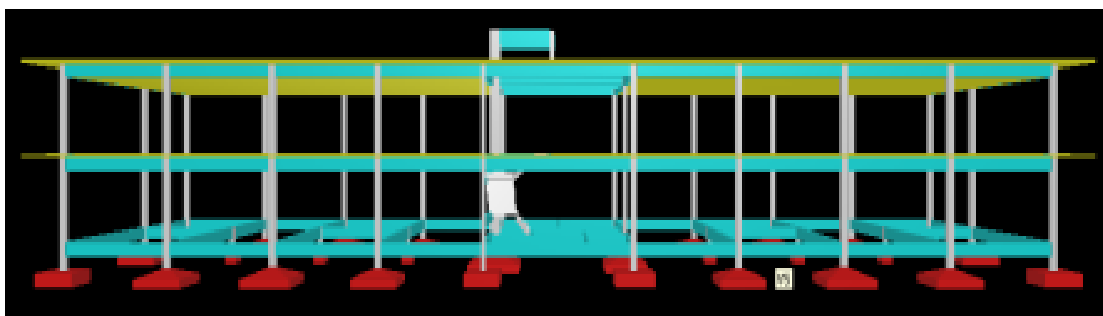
Pórtico 3D da estrutura com laje nervurada.
